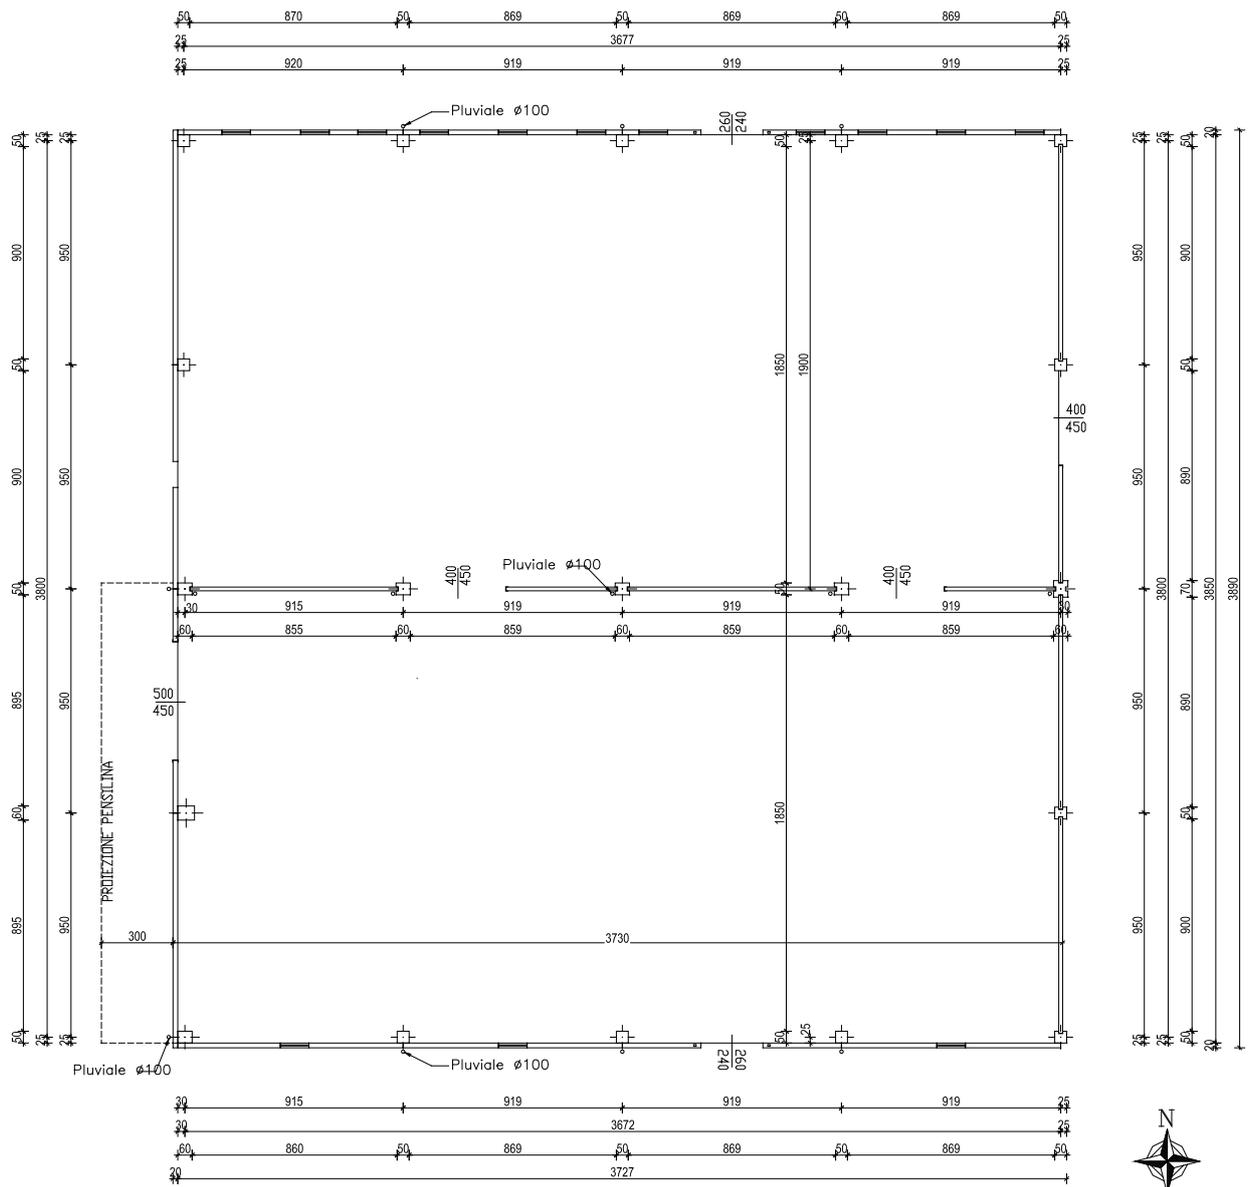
Pianta edificio prefabbricato monopiano (anno 1996)
